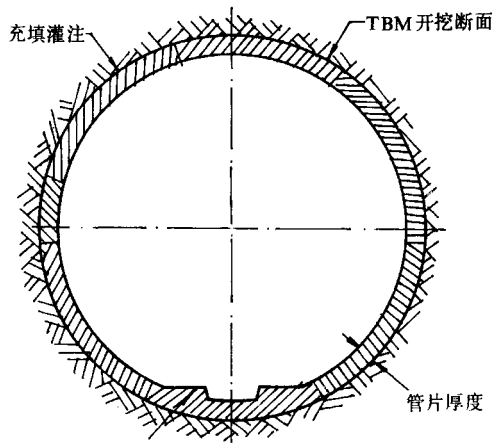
全周预制钢筋混凝土管片衬砌示意图
